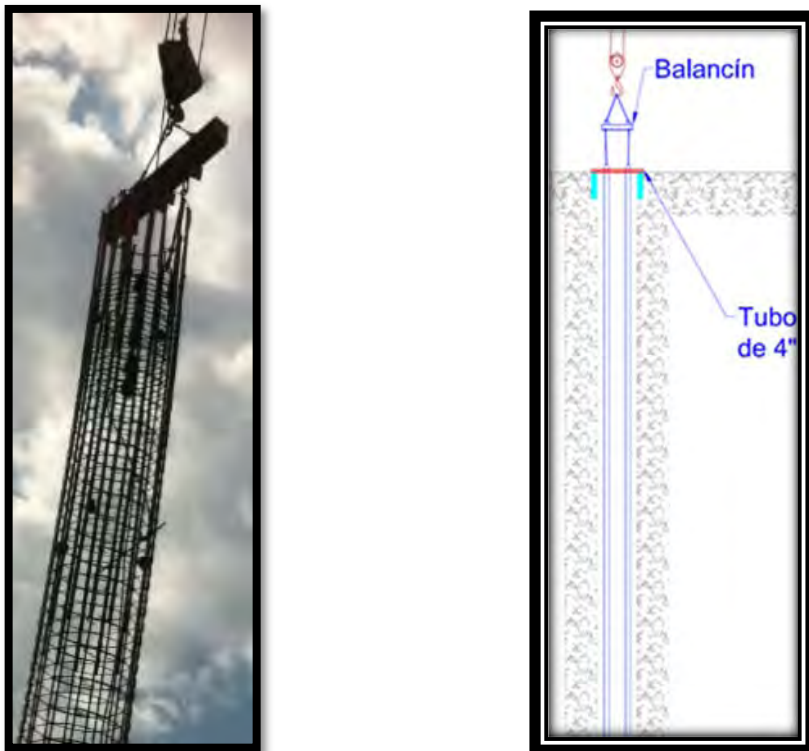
Izaje del armado de acero de pila circular y colocación de orejas.
